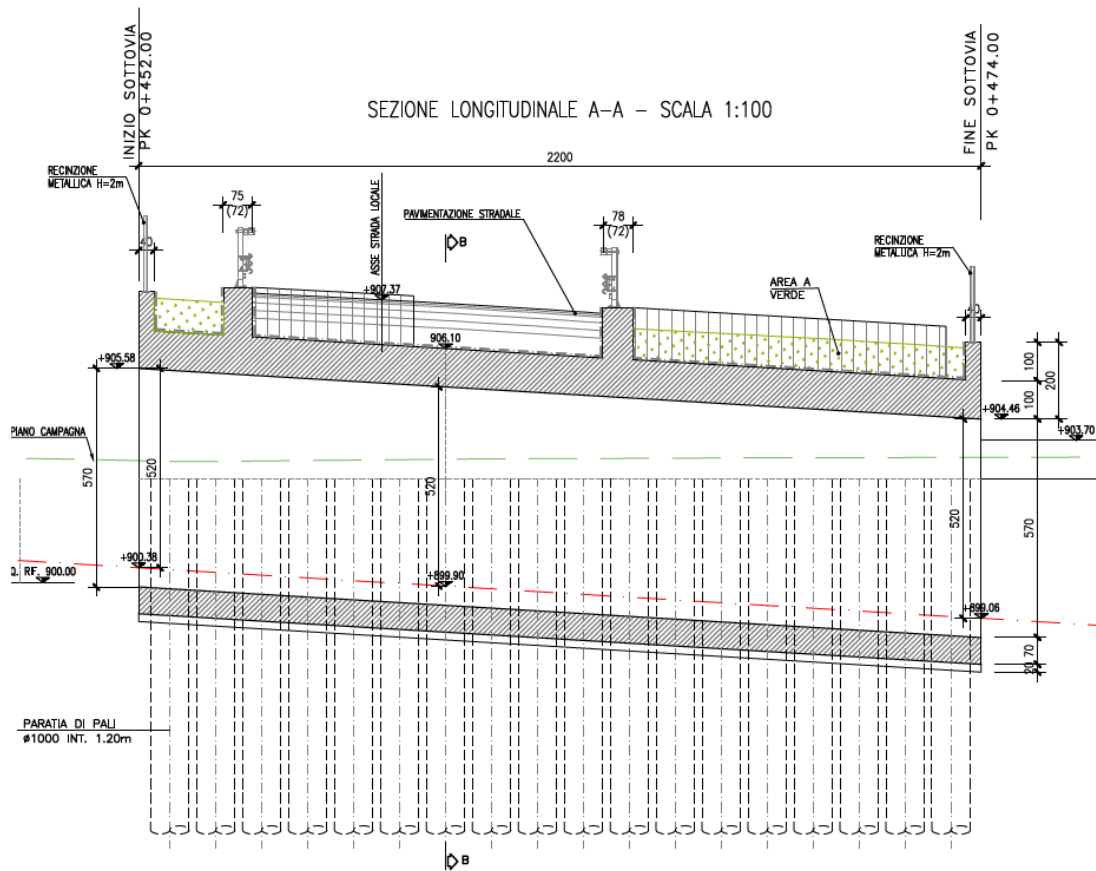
Sottopasso ST01– Sezione longitudinale A-A
